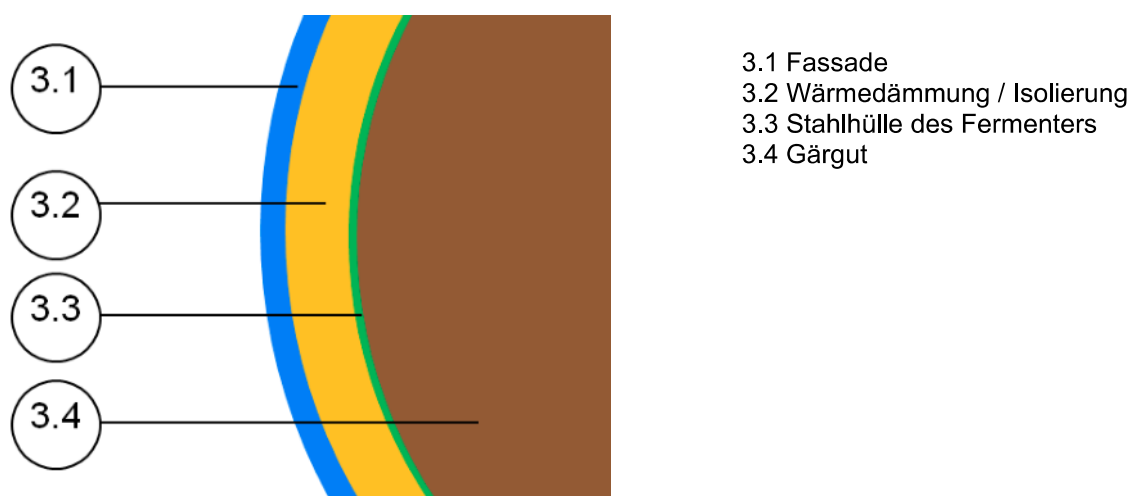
Fassadenaufbau Fermenter im Querschnitt
